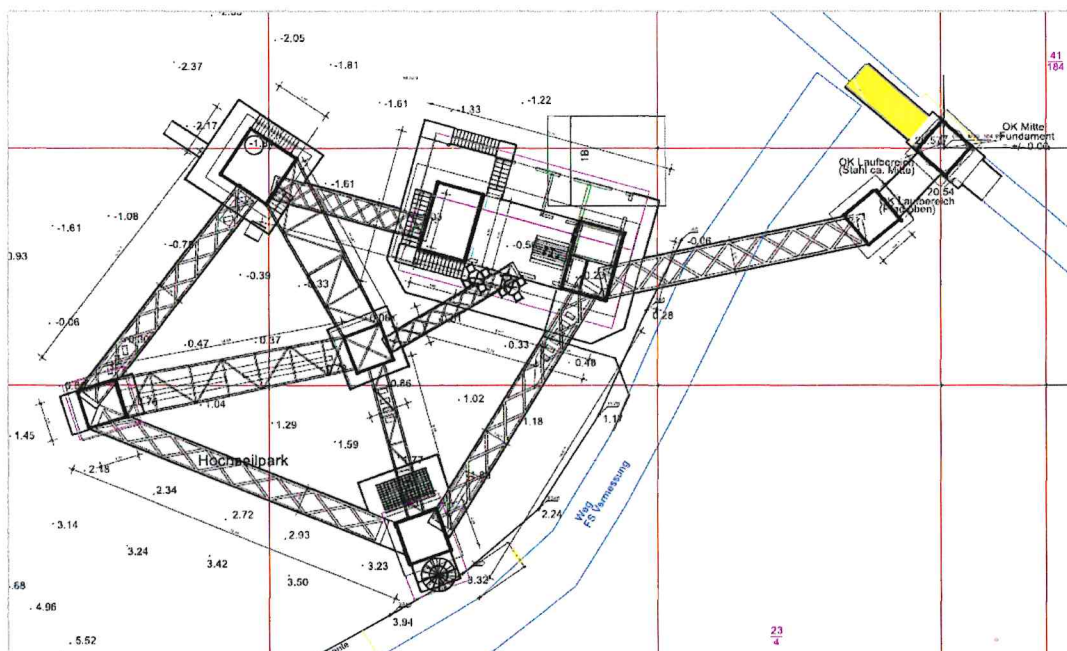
Lageplan der geplanten Eventtürme, Quelle: BaumSchwebeBahn Bad Harzburg GmbH
